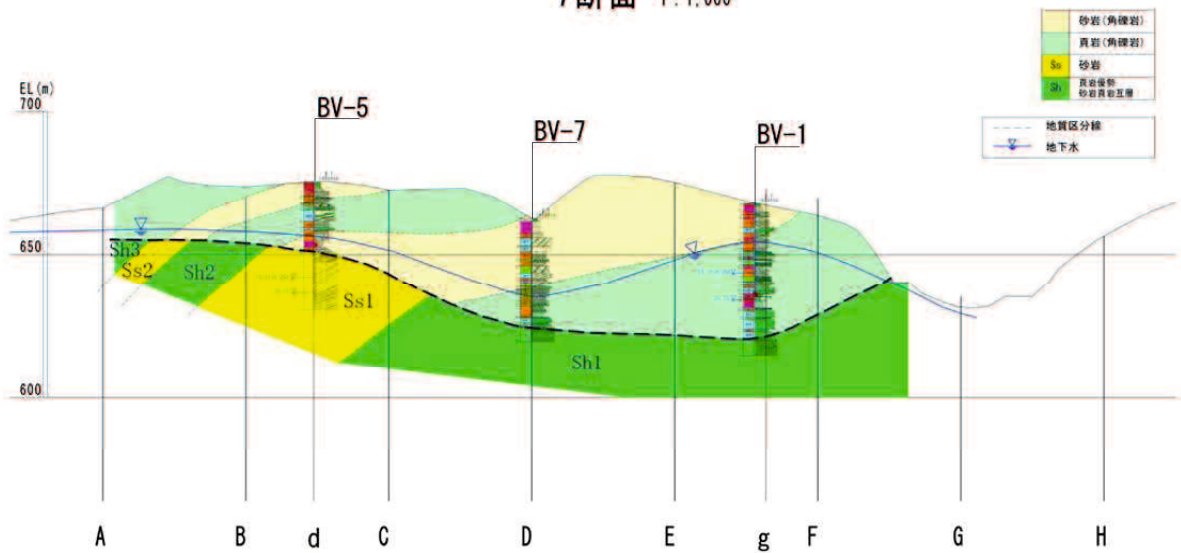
二畝の谷斜面の地質断面図 (7断面)
